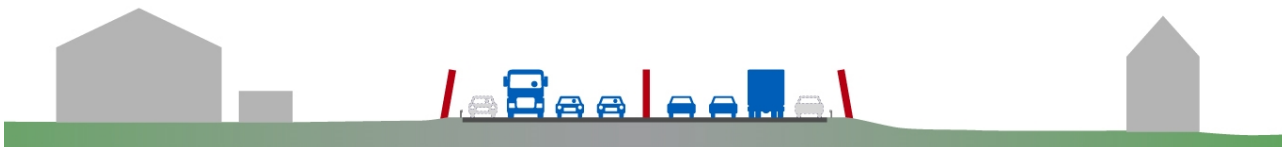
Facadestøjniveau ved boliger med eksisterende 4 meter høje støjskærme
